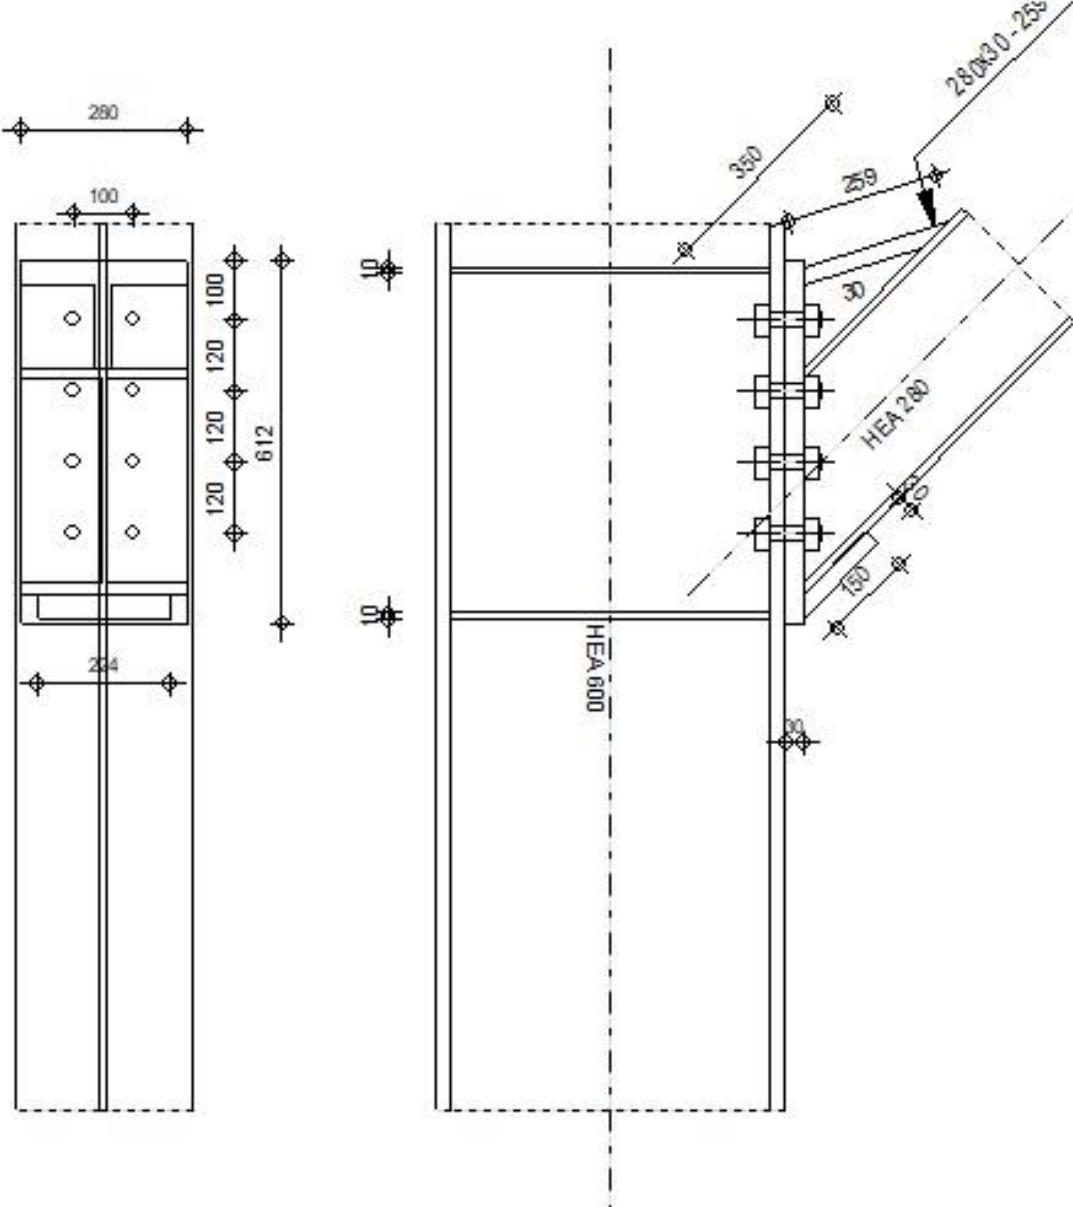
Disposition constructive de l'assemblage Poteau Contreventement.
